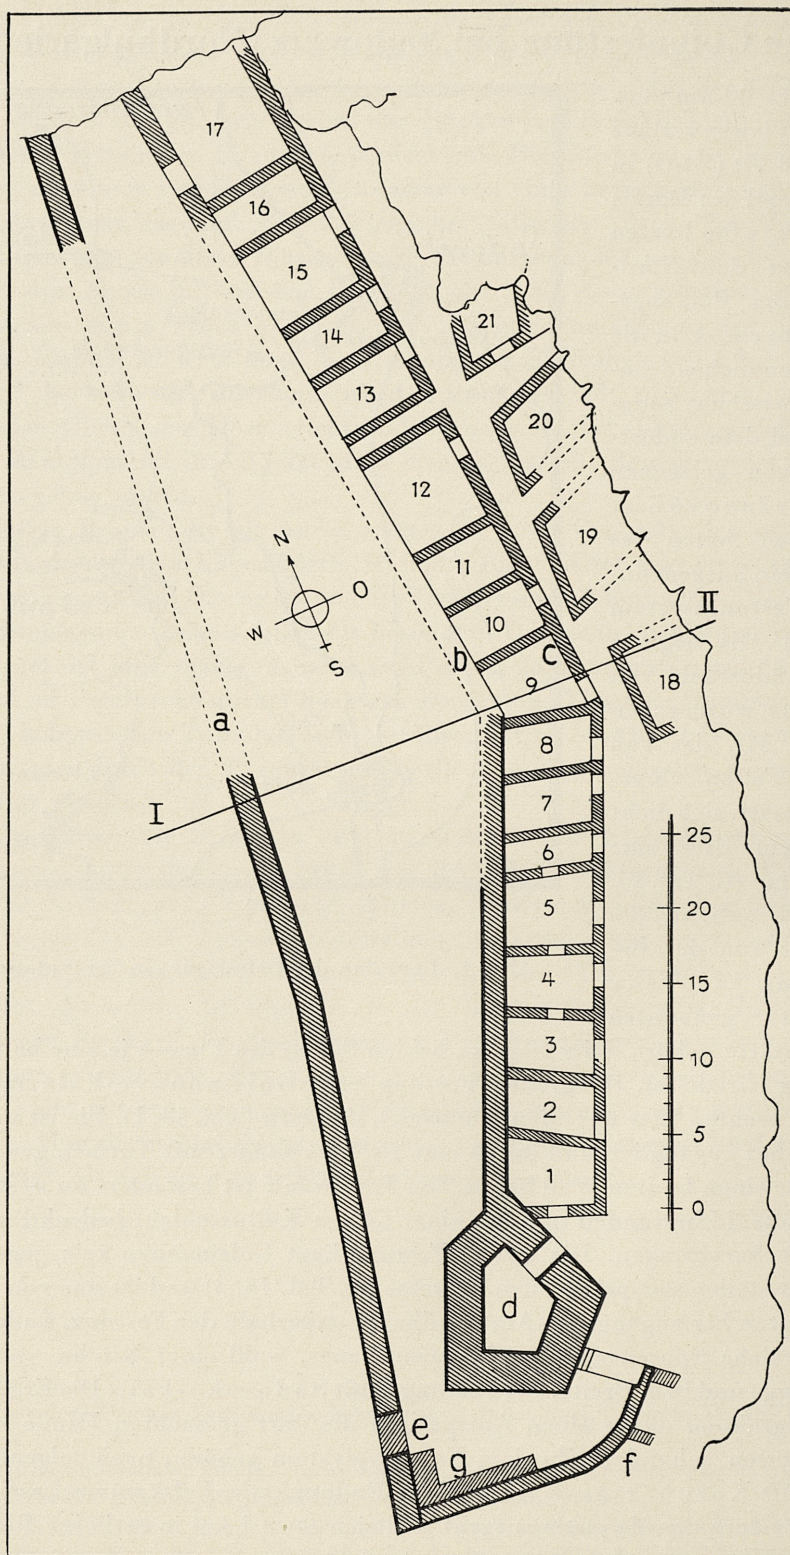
Lageplan der Festung Sadowetz. 1:500.
